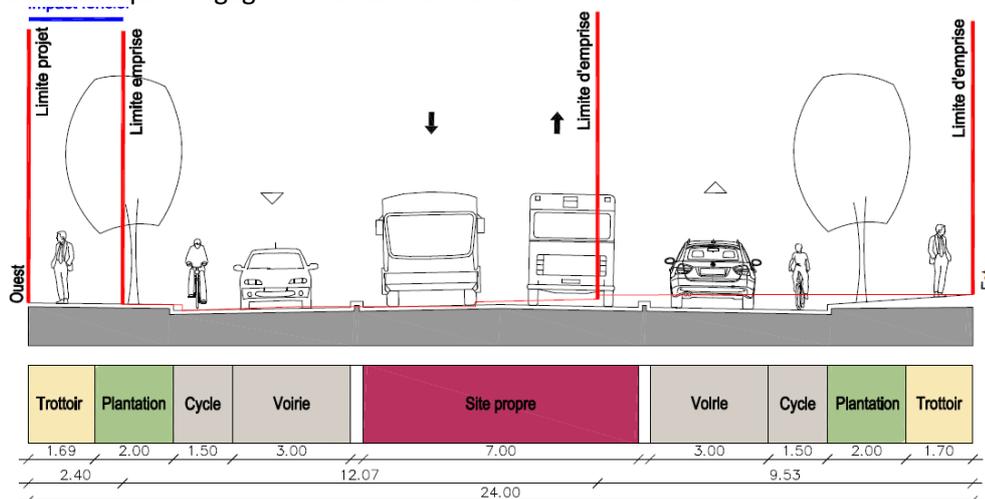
Coupe type en section courante sur la RD392¹⁷
